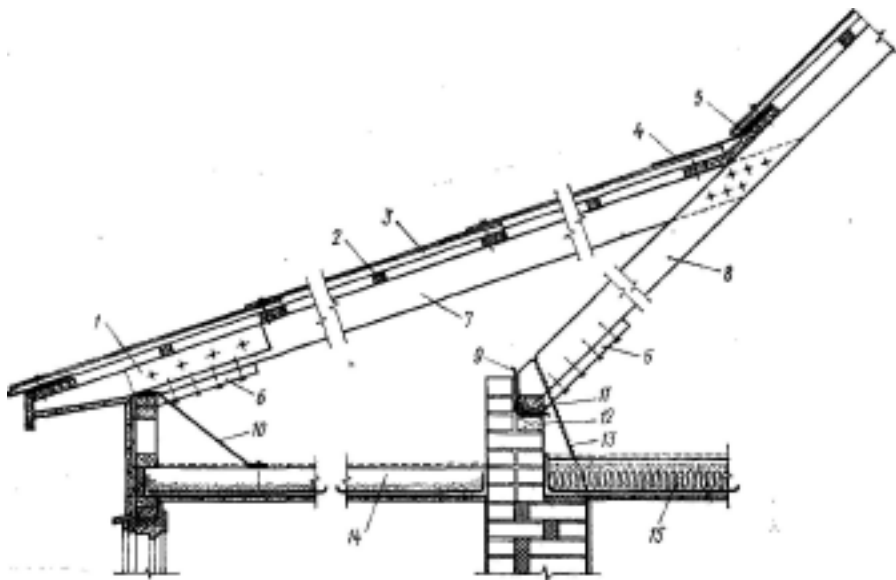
Крыша и чердачное перекрытие над верандой (сечение /—/ на I рис. X.1, в):
